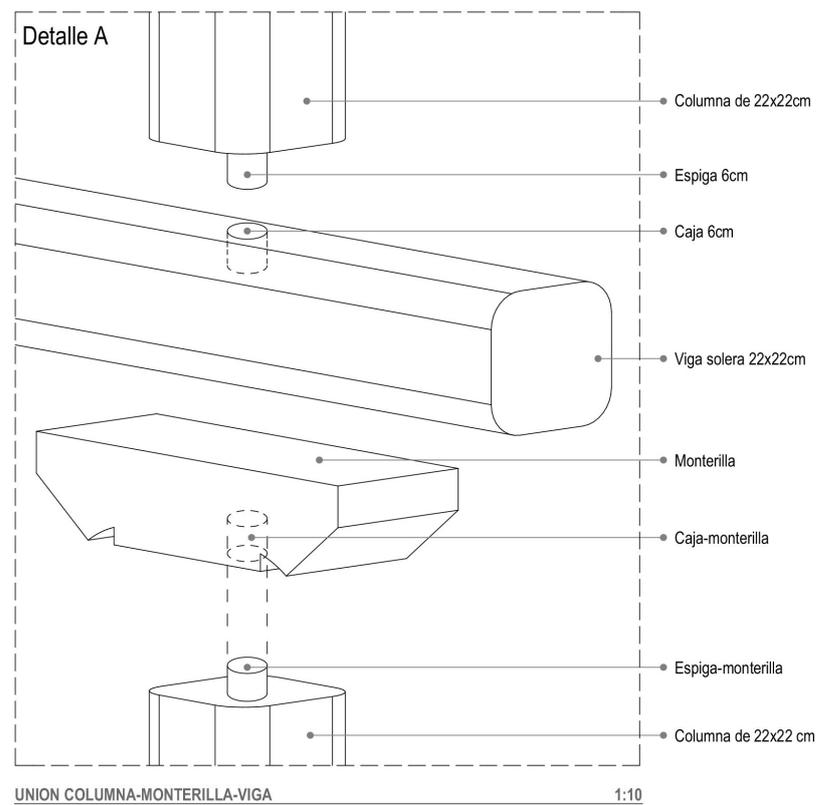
Representación gráfica, detalle A columna, monterilla, viga
